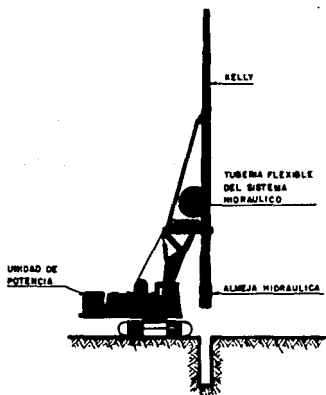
Almeja hidráulica guiada, montada sobre equipo de excavación
